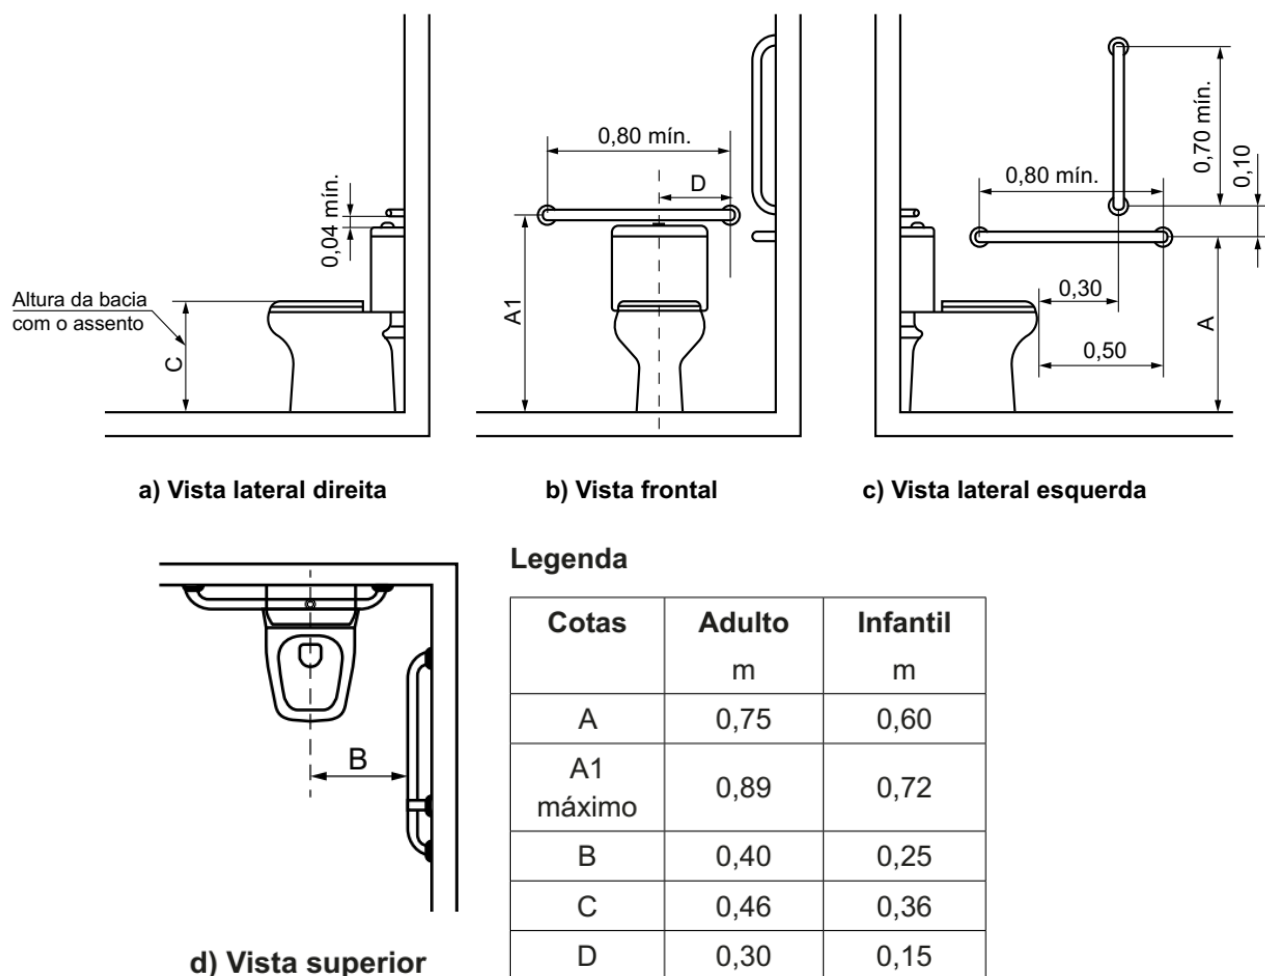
Instalação de barras de apoio na bacia sanitária, do banheiro da sala de observação, do segundo pavimento – Fonte: NBR 9050
